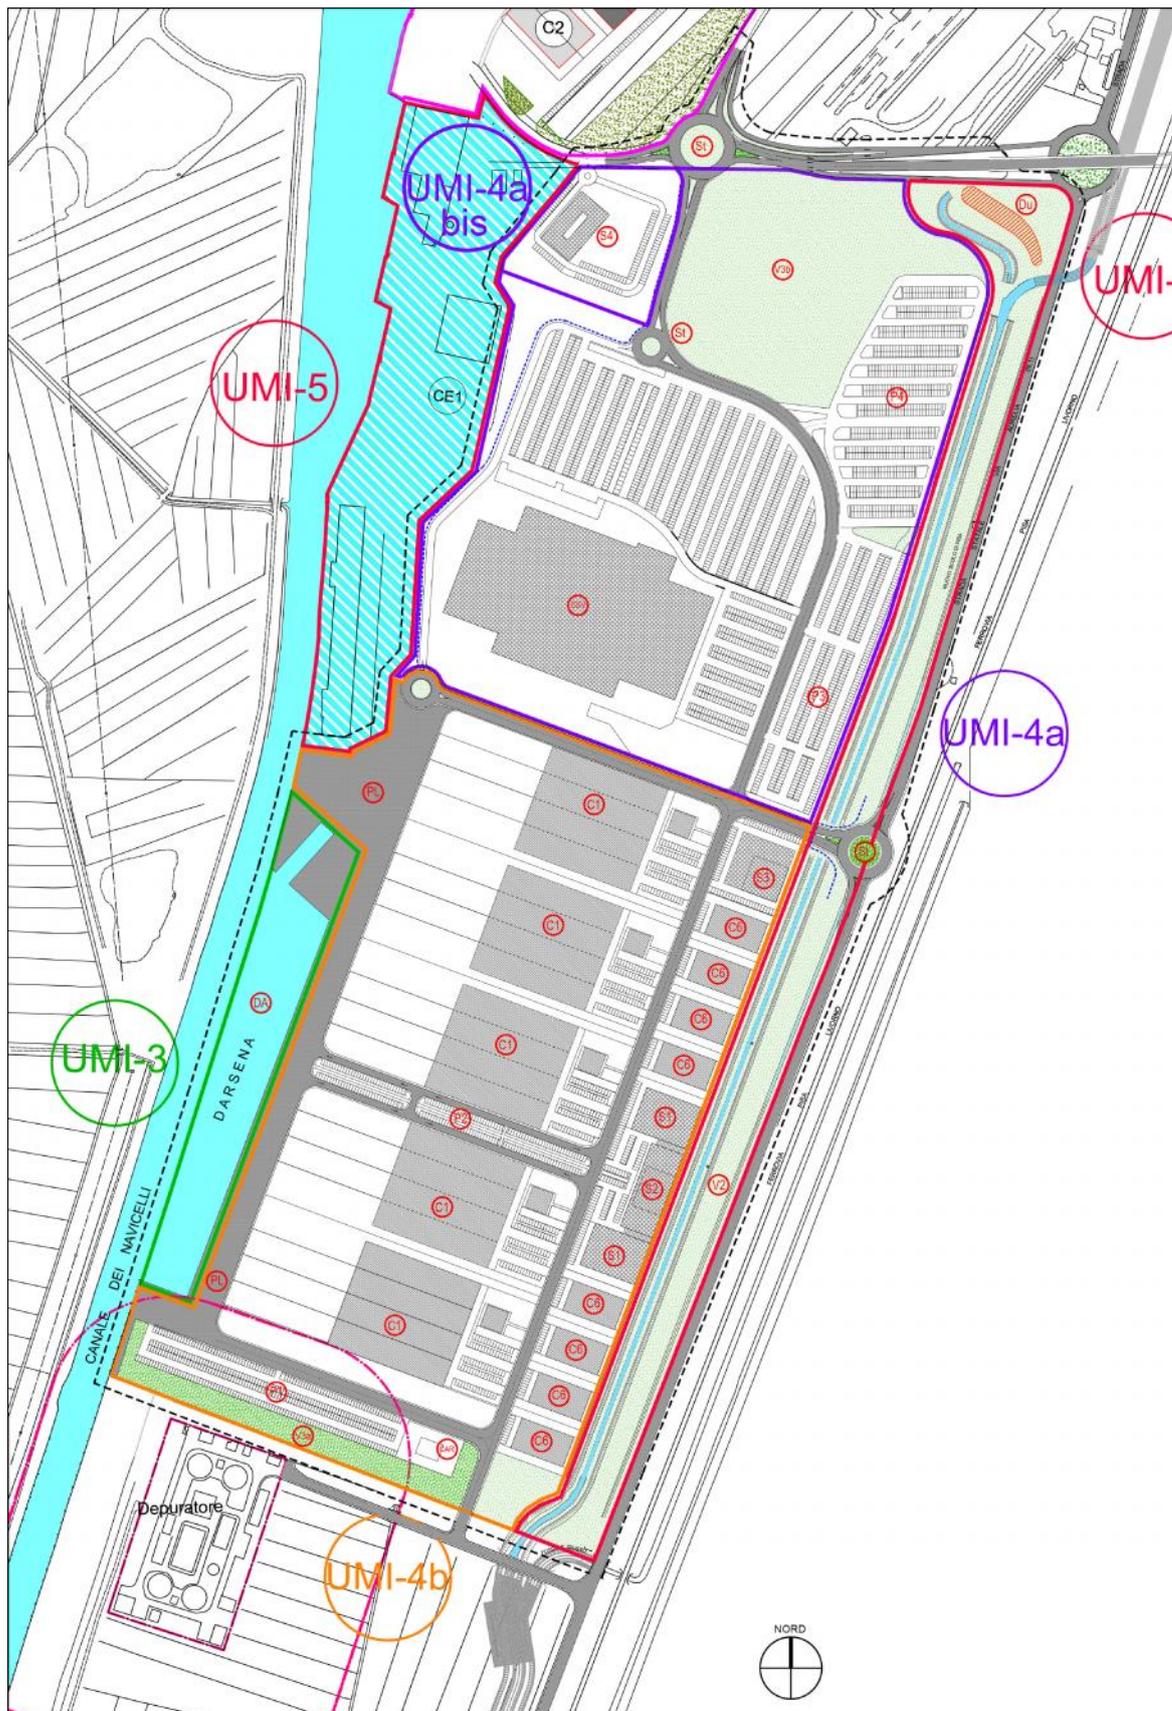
STATO ANTE PIANO ATTUATIVO 2005
